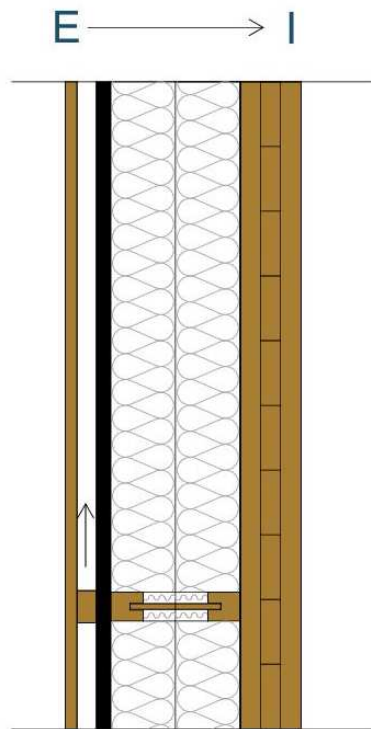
CLT konstrukce stávajícího řešení detailu nároží obvodových stěn – oblast kondenzace
